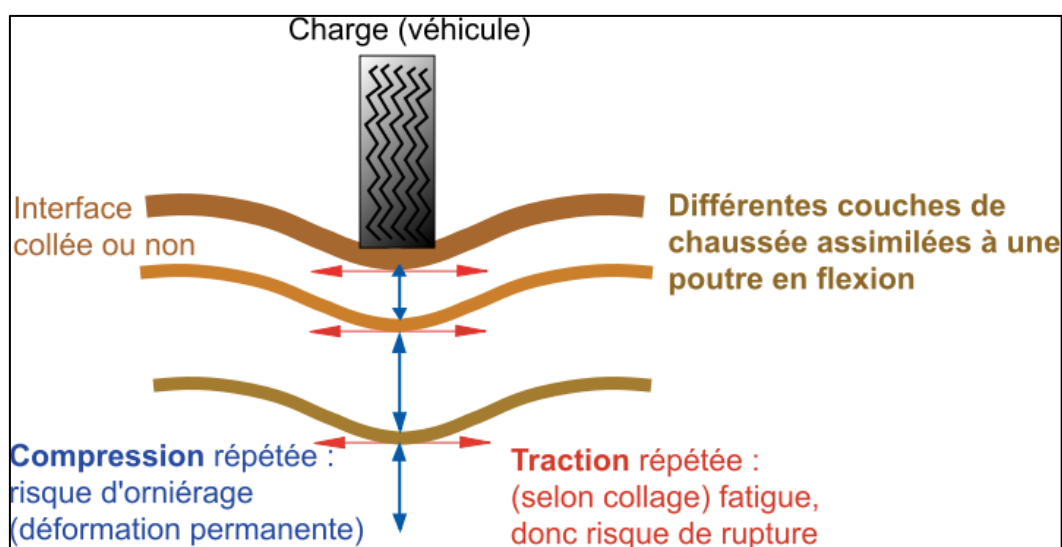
Schéma de fonctionnement d'une structure de chaussée sous l'application d'une charge roulante.
